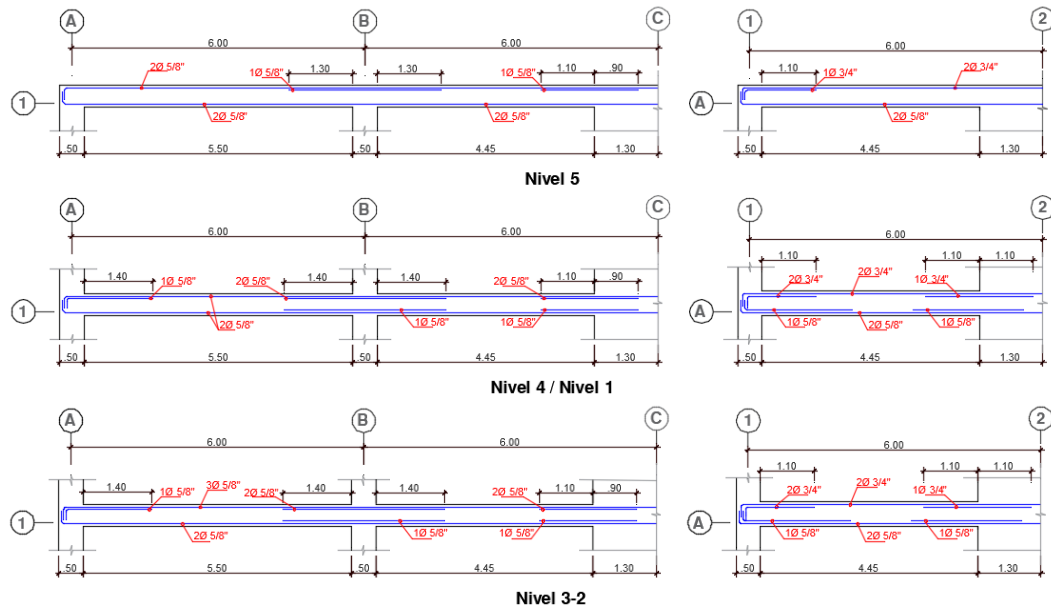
Refuerzo convencional requerido por flexión en las vigas para el edificio Edi-05
